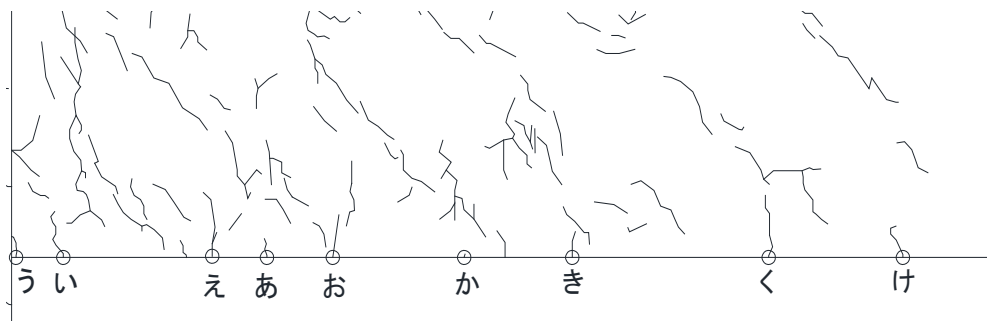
基礎梁ひび割れ幅測定位置(試験体 C-3 正載荷)
